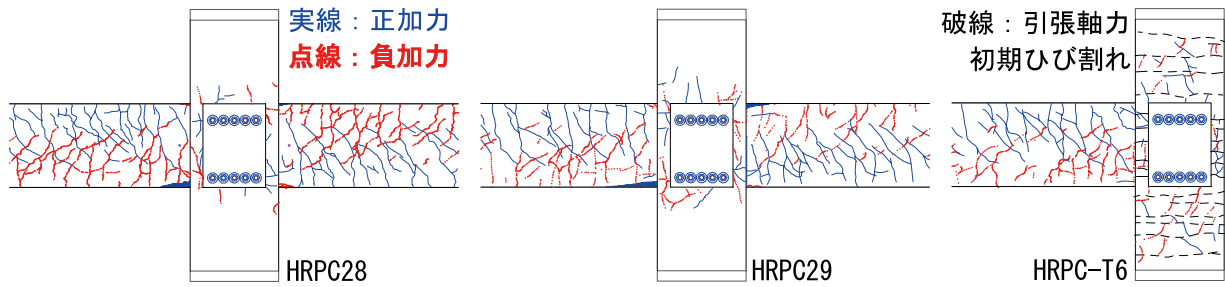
1/50rad. 時ひび割れ発生状況図
